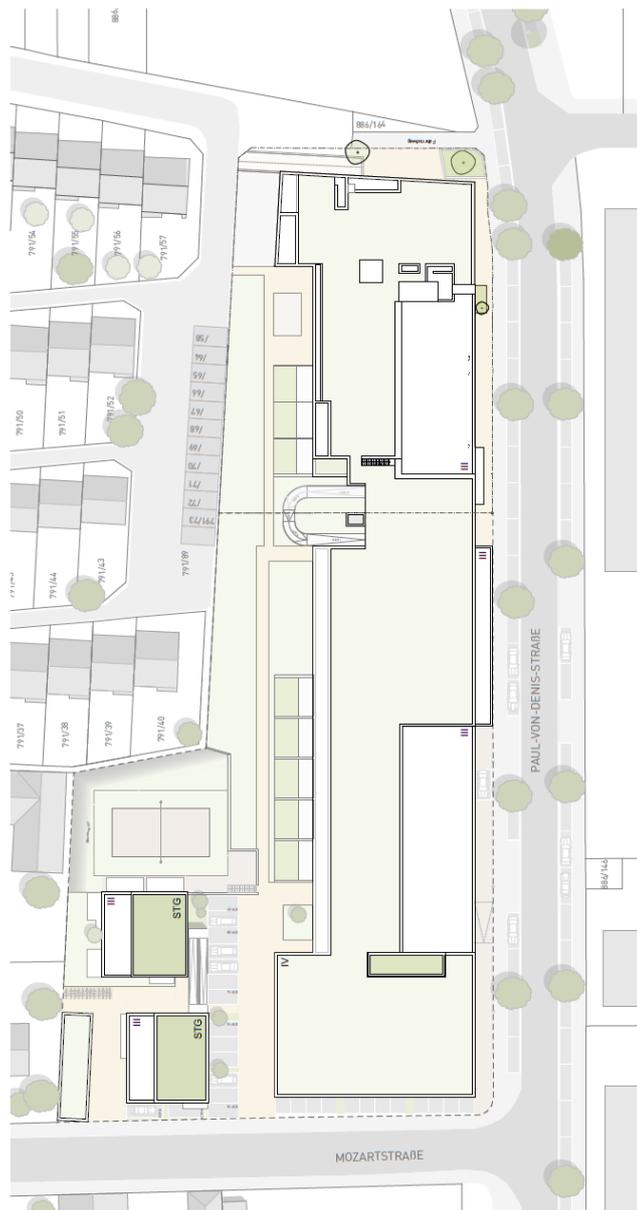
Lageplan Fitter Campus von hausgemacht Architekten GbR, Stand: 11.04.2023
